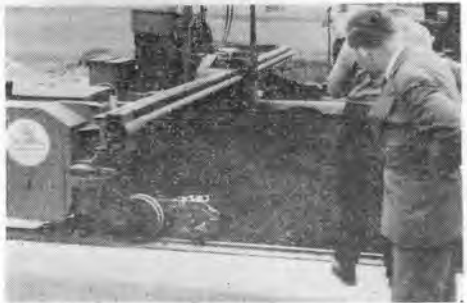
アスファルト合材を敷均し中のフェーゲル社のコンクリートスプレッダ フランクフルト付近 アウトバーン工事現場
